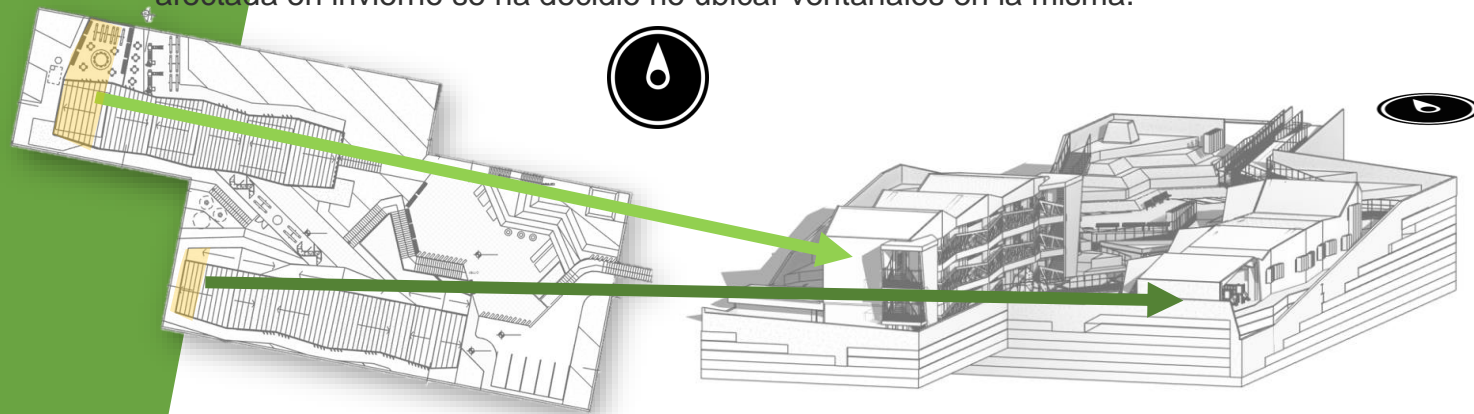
PROTECCIÓN DE LA FACHADA OESTE
